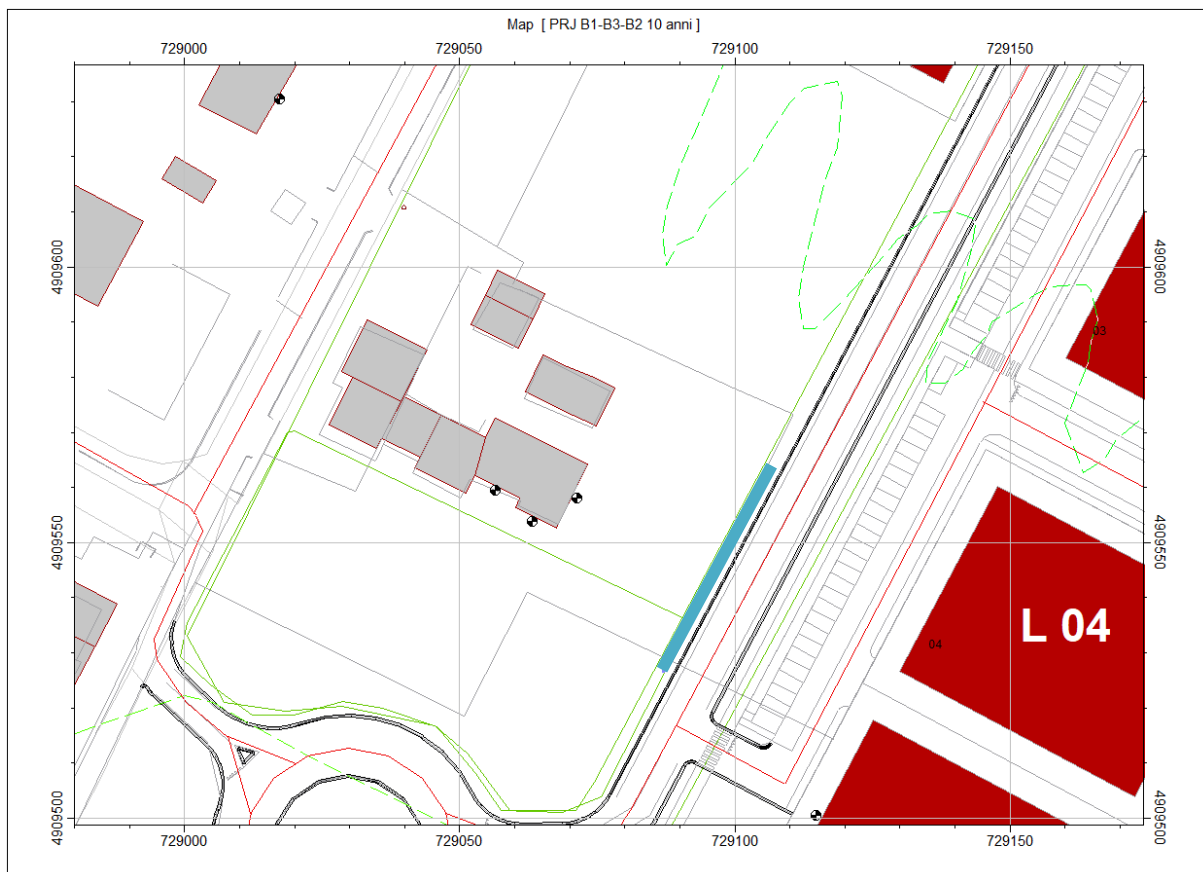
Localizzazione planimetrica della mitigazione proposta per il recettore E-21-B
